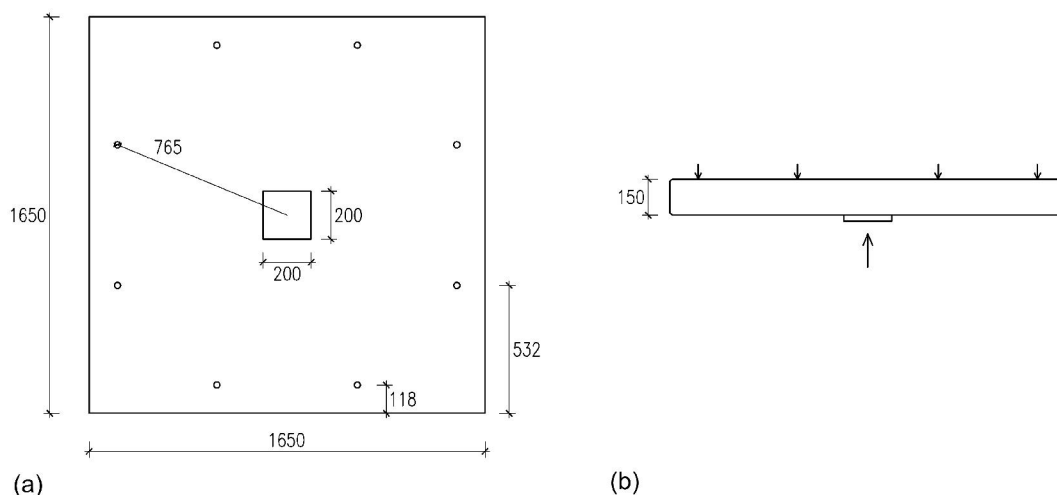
Geometria dos modelos [mm]: (a) Vista em planta; (b) Vista em alçado.
